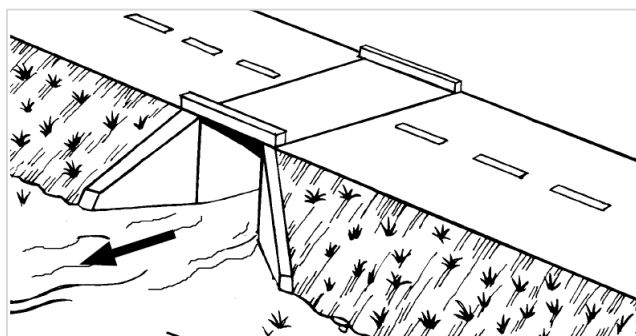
Perspectiva de una alcantarilla de cajón (*box-culvert*) de concreto hidráulico reforzado
